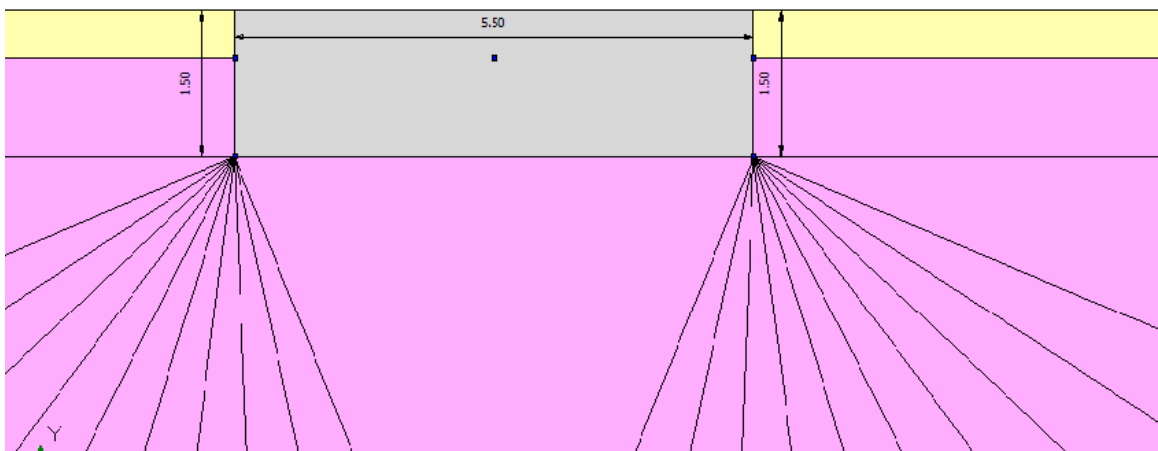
Sezione fondazioni – stratigrafia (dettaglio)
